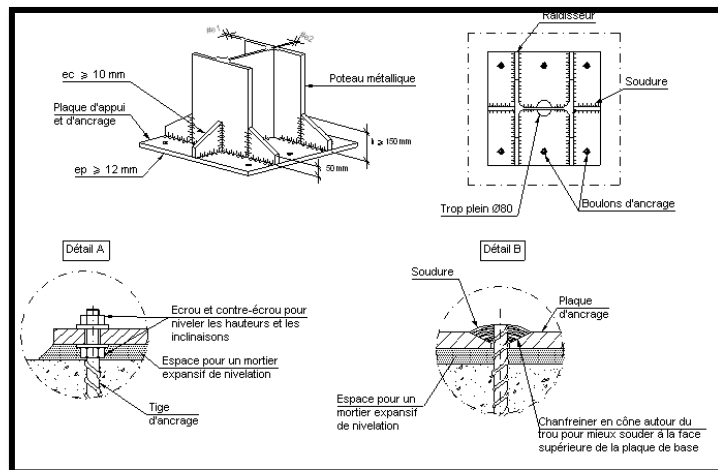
Détails technique de l'encastrement d'un poteau métallique
